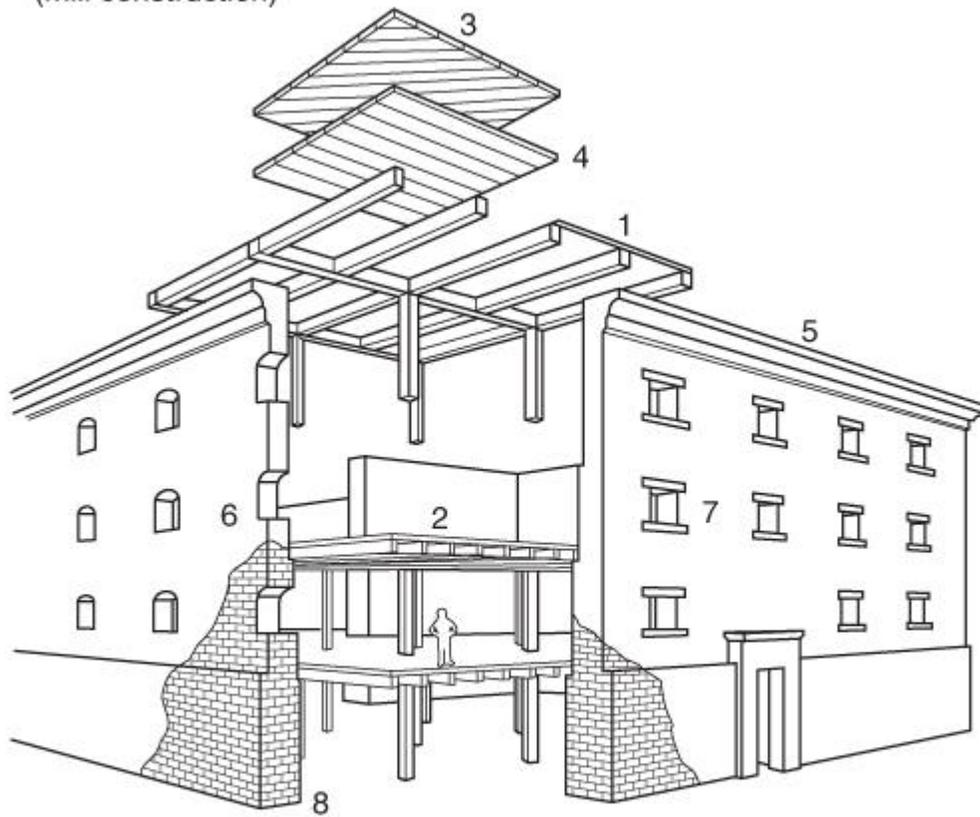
(m) sin refuerzo muro de mampostería, el Ejemplo 2 de 3 de cojinete.
